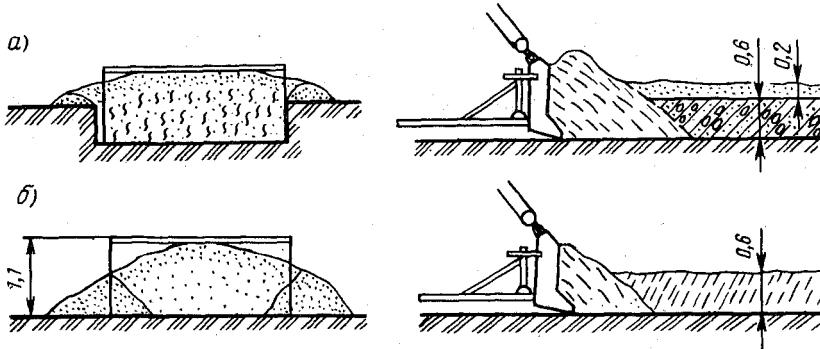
Схемы перемещения грунта бульдозерами по траншеям
